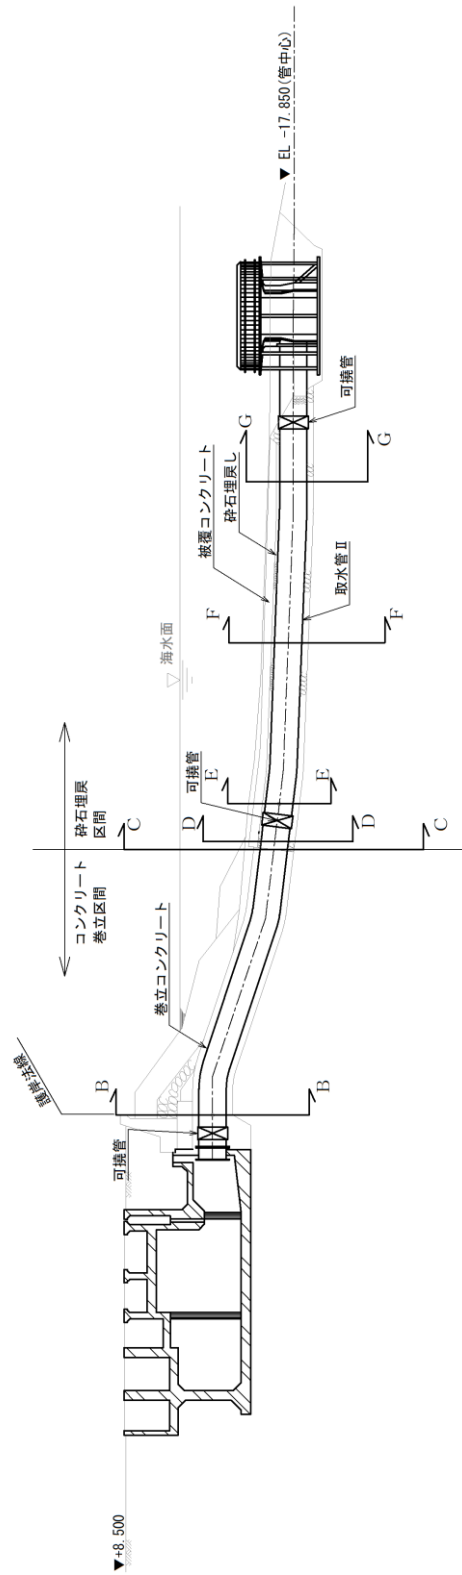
(1) 取水管 断面図 (A-A 断面)
